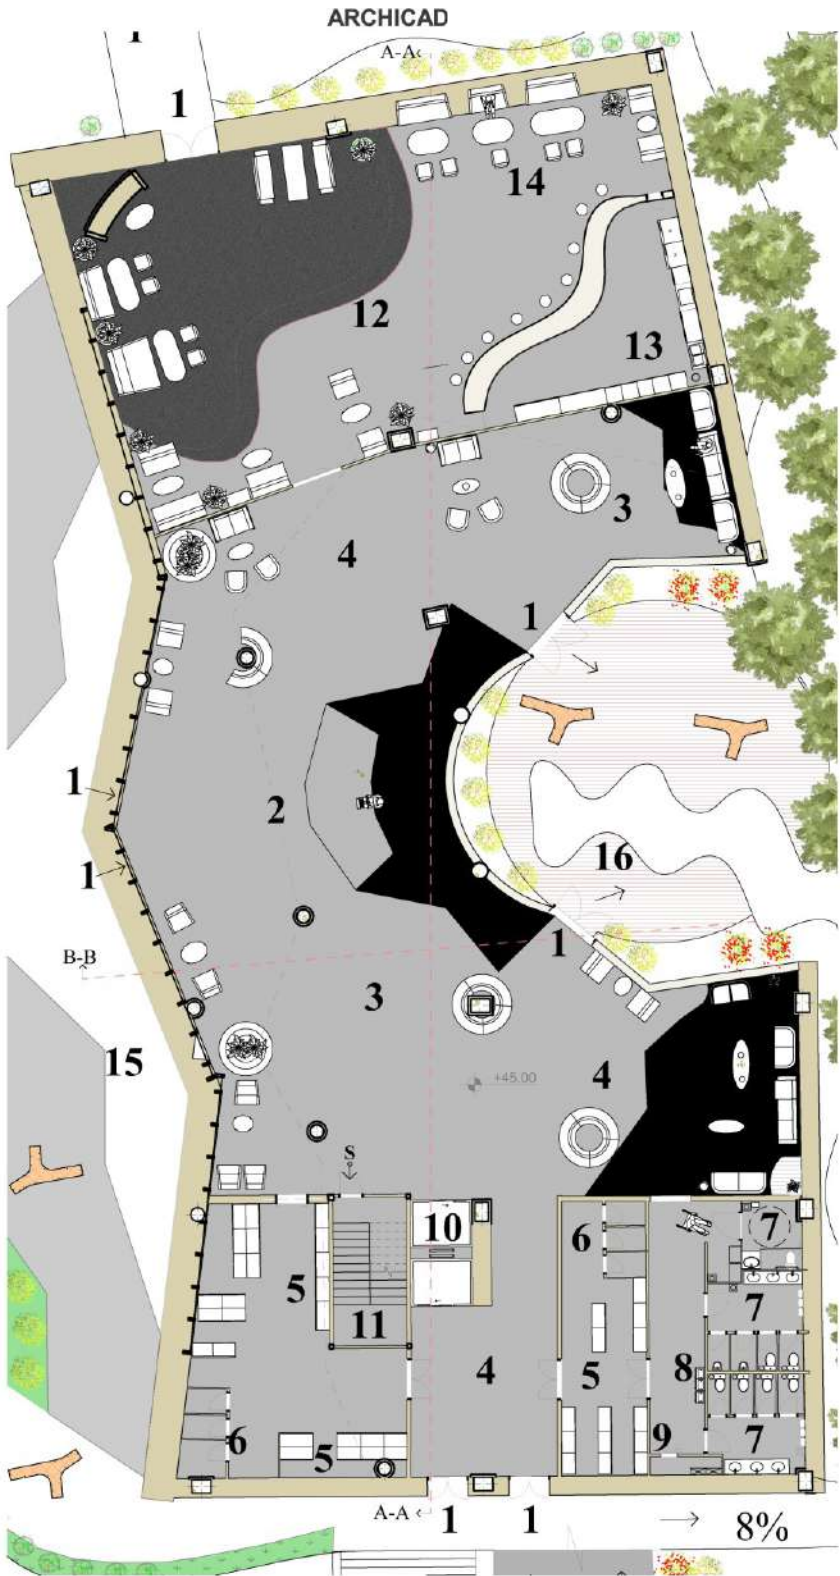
Planta Arquitectónica de nivel 00, edificio A, elaboración propia, 2024.
